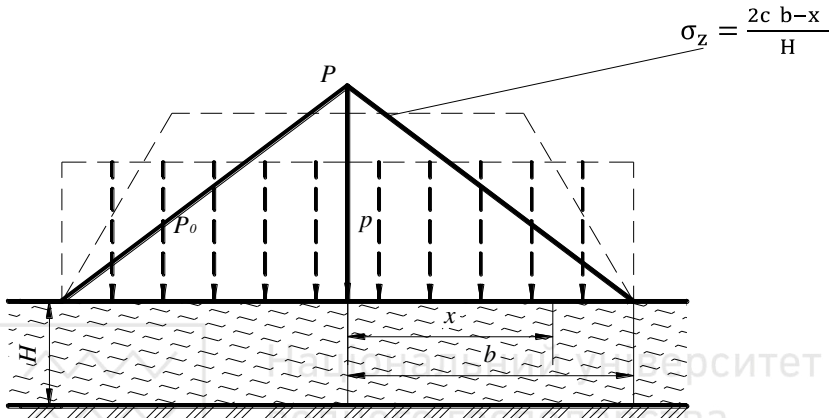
Схема до розрахунку стійкості насипу на тонкому шарі слабого ґрунту
